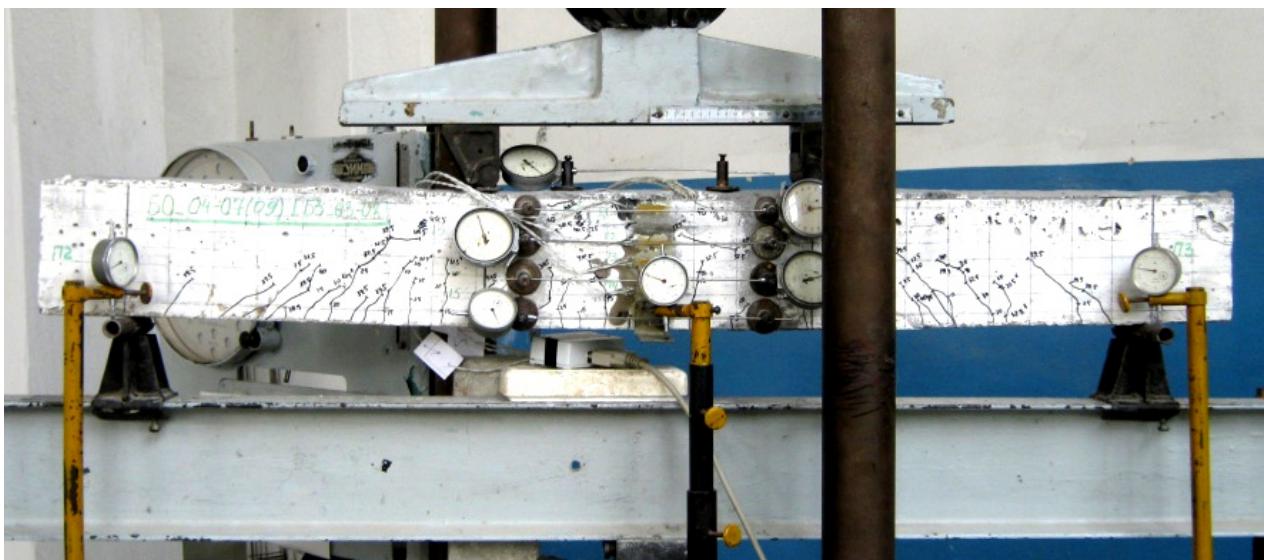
Испытание опытной балки, усиленной наращиванием сжатой зоны
